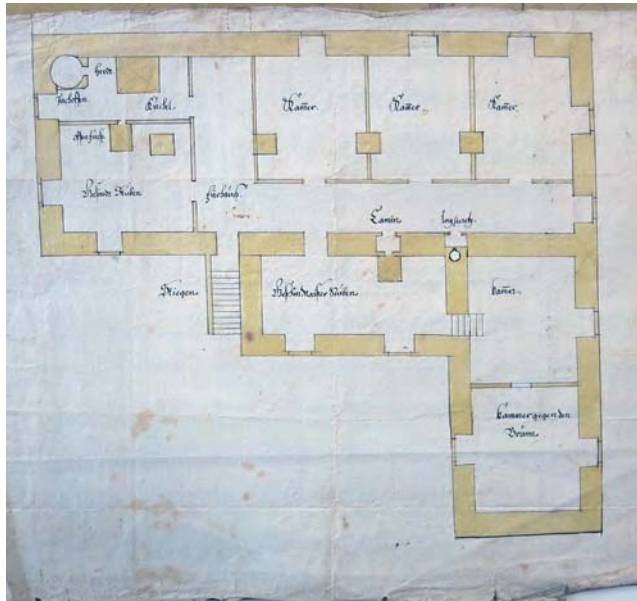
Umbauplan Grundriss Geschirrhofs 1675
